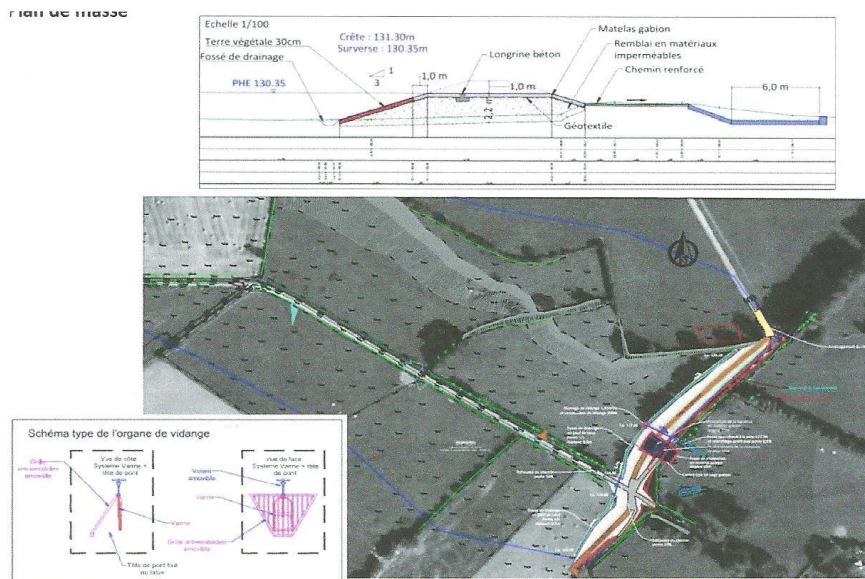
Extrait du plan de masse – Ouvrage E16-10
